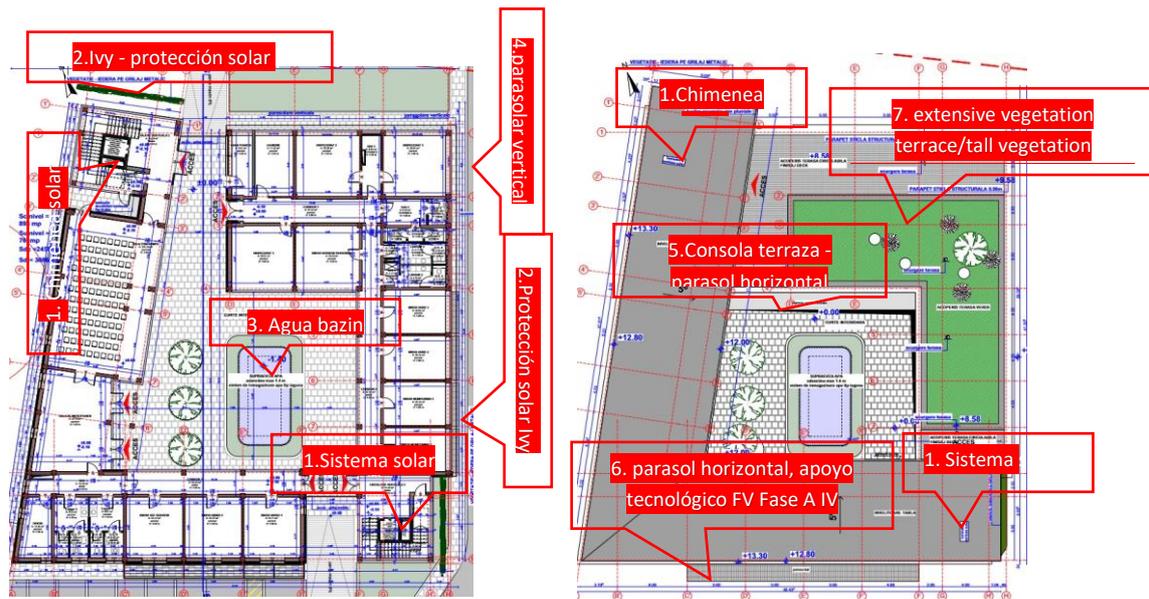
FASE II Dibujos CAD, concepto Dițoiu Nina-Cristina⁸ - Planimetría: planta baja/tejado proyecto inicial mencionando arquitectura bioclimática relevante: 1. Chimenea solar (ventilación natural, espacio de circulación vertical); 2. Hiedra en un marco metálico - protección solar; 3. Piscina de agua en el patio interior (bienestar durante el verano); 4. Sistema de sombreado vertical - orientación Oeste; 5. Terraza voladiza orientación Sur - orientación Oeste. 5. Terraza en voladizo orientación Sur - Protección solar horizontal; 6. Protección solar horizontal metálica (Estructura metálica que soporta paneles fotovoltaicos); 7. Terraza de vegetación extensiva / vegetación alta (bienestar)
